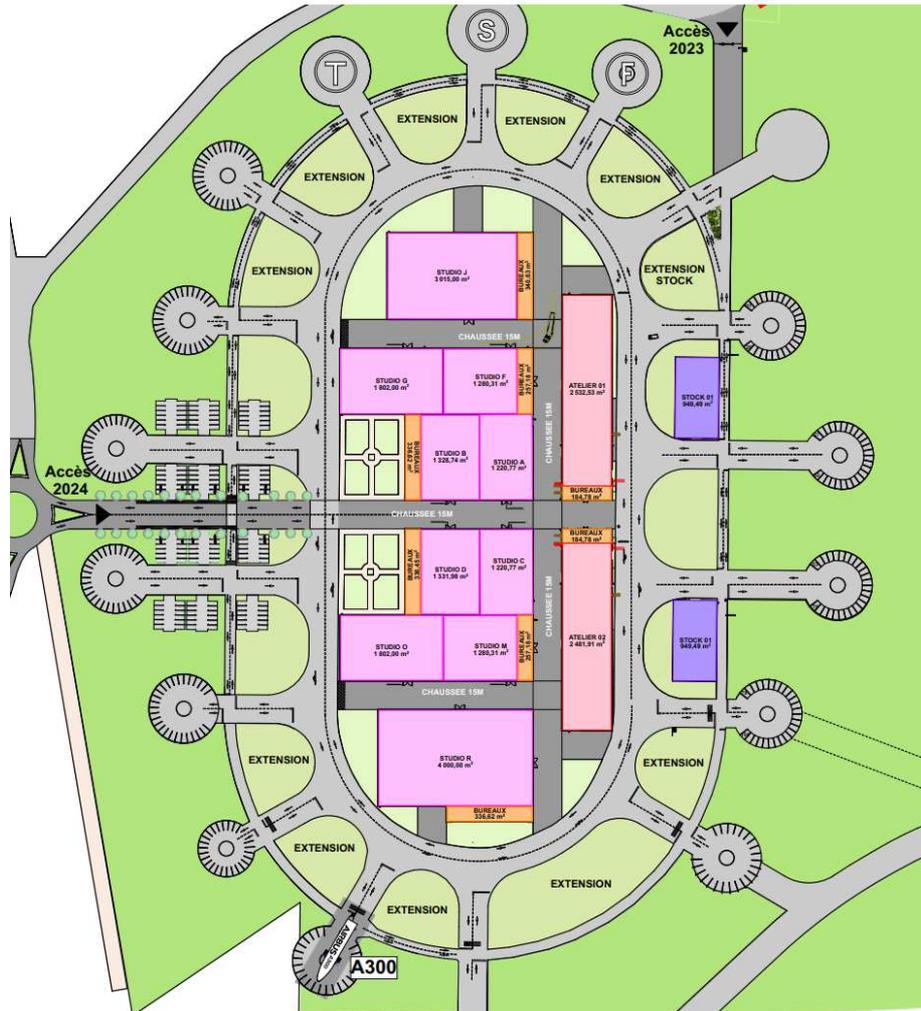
Plan de masse des ouvrages projetés sur la Marguerite Ouest, source : Document n°7
